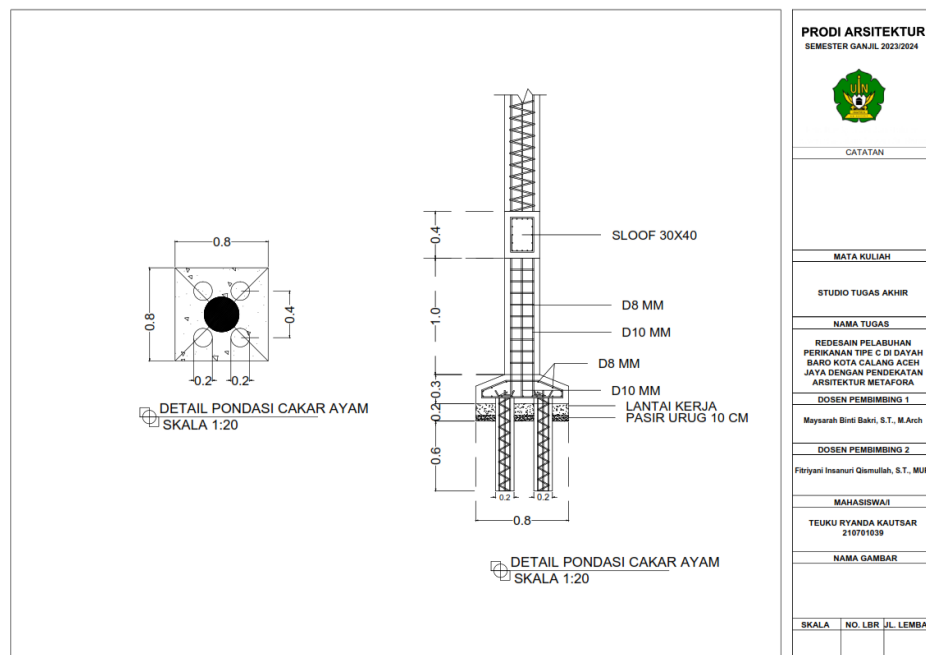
22 Denah Pondasi dan Sloof Kantin
